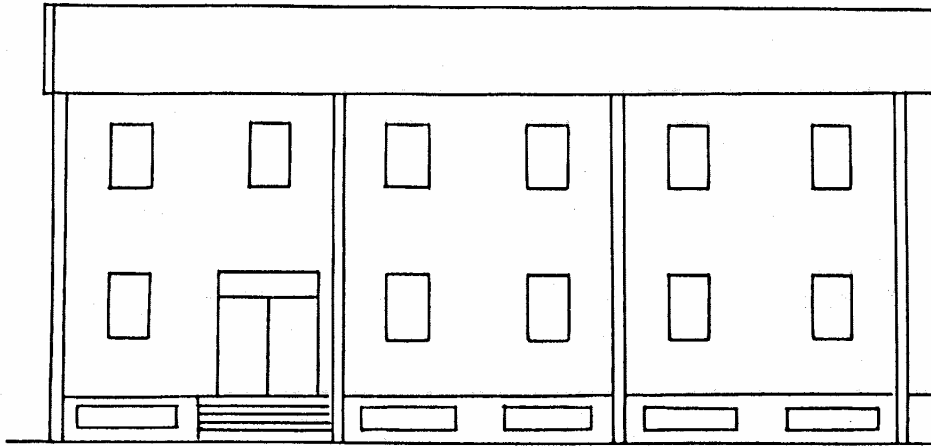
SECTION TYPE D'UN BATIMENT DE LABORATOIRE
